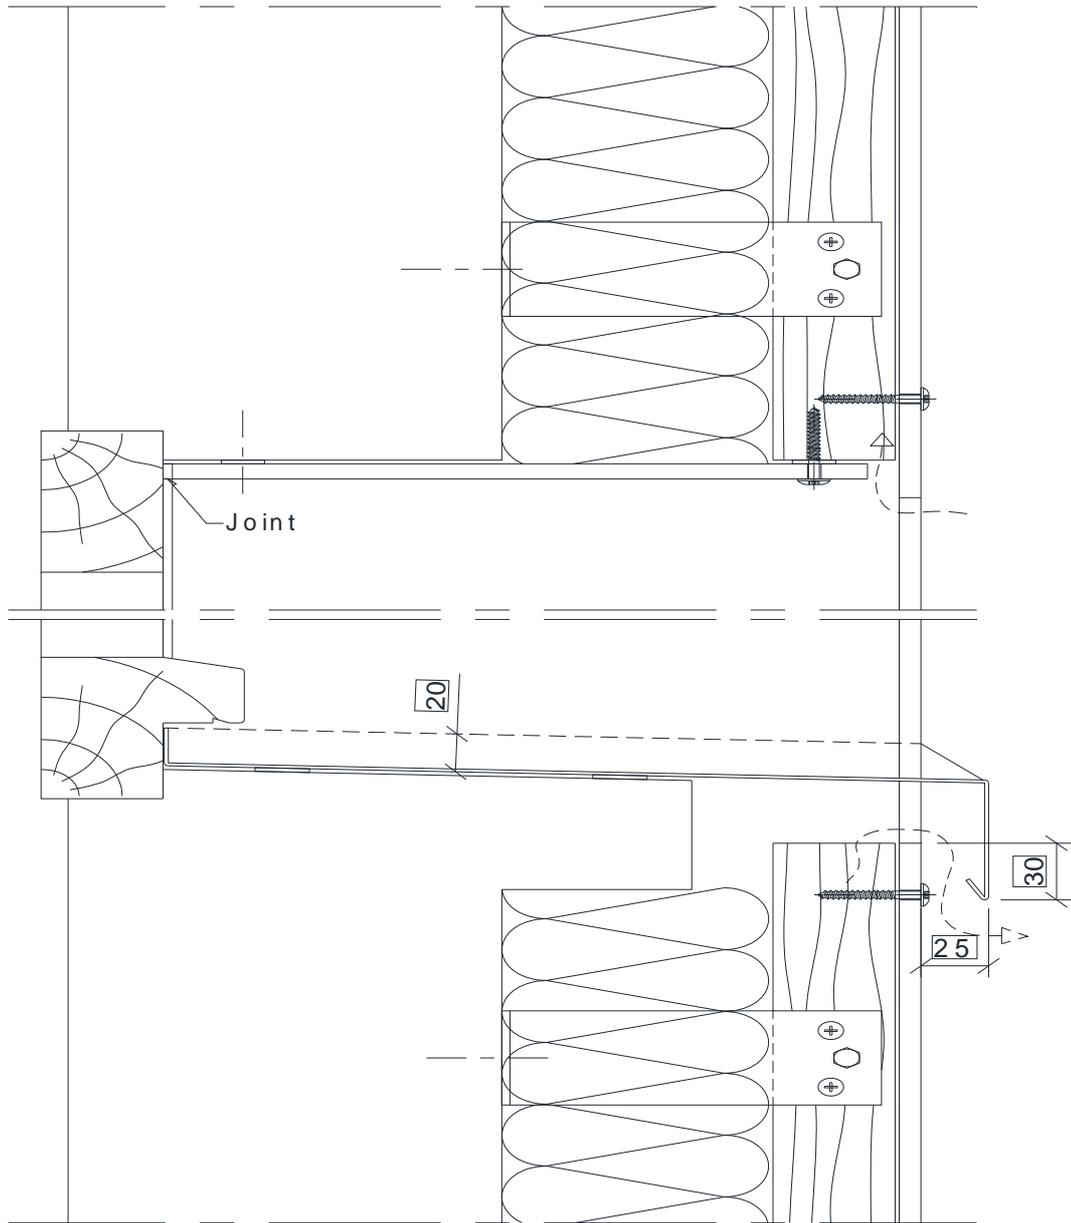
Encadrement de baie sans isolation complémentaire – Coupe verticale - Pose en vêtage
